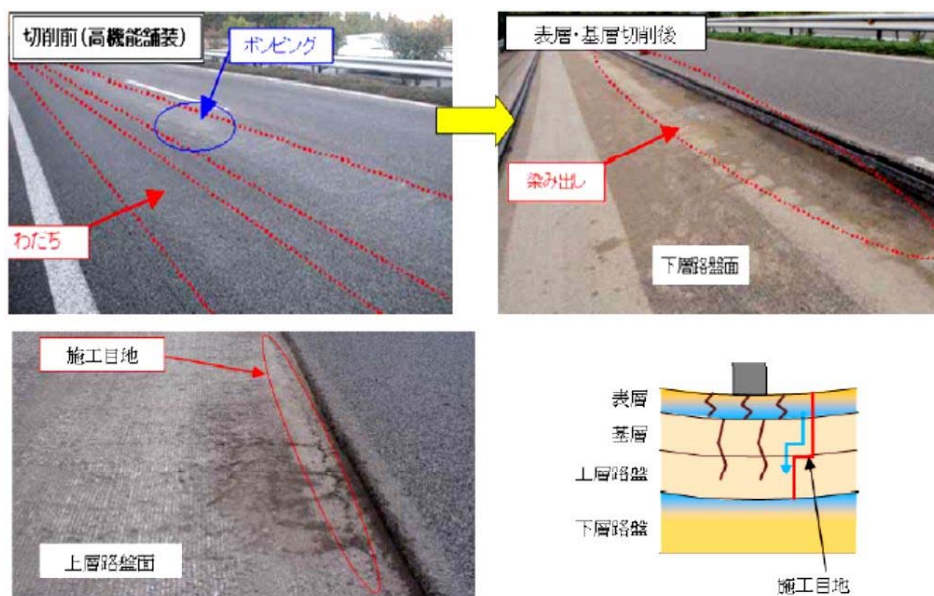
施工目地部からの染み出し水とひび割れが発生した路盤⁹⁾
